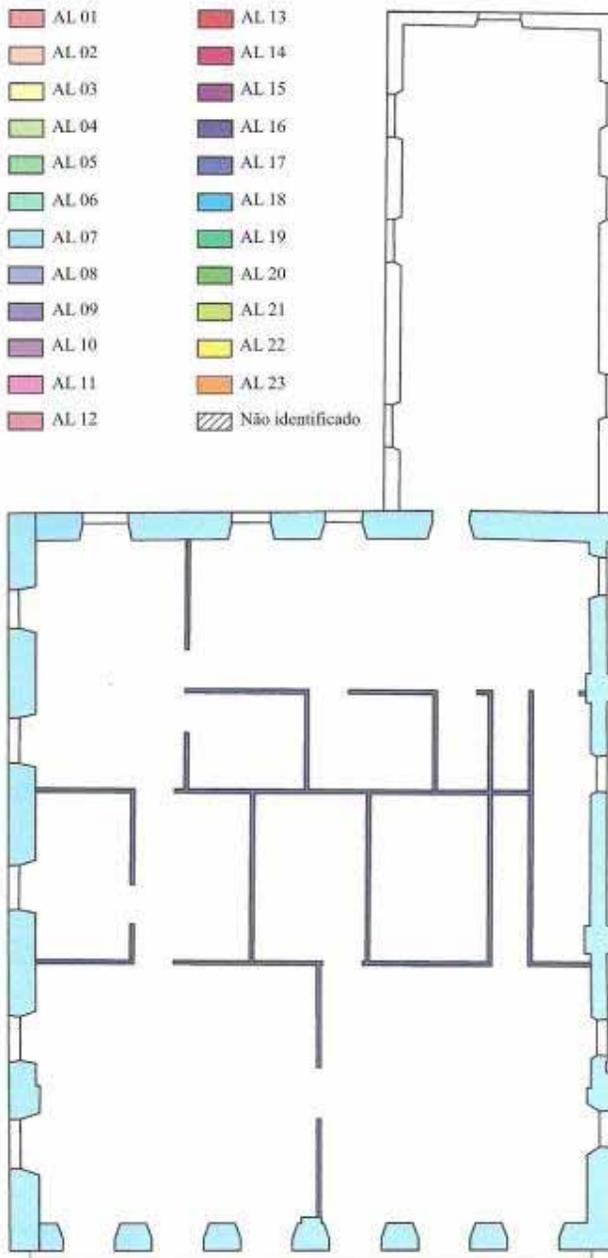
Planta Baixa do pavimento térreo com identificação e localização dos 23 tipos de alvenaria da casa grande sobre a base gráfica. Fonte: Figura pela autora.
